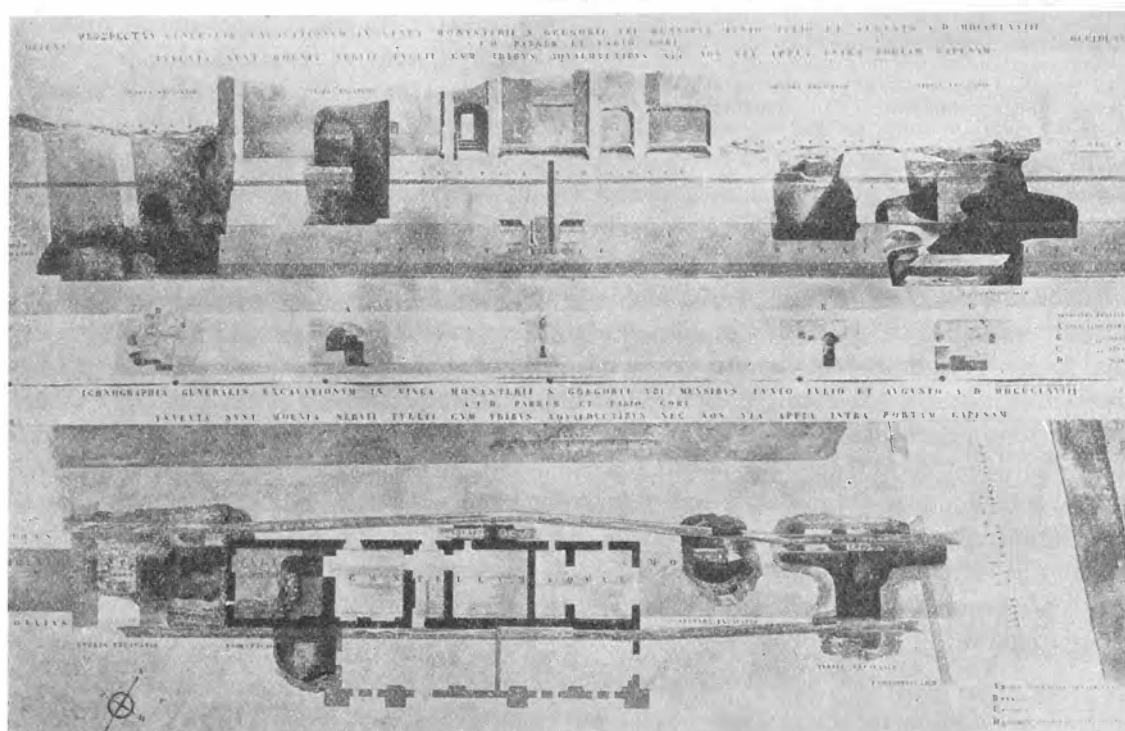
Pianta e prospetto dei ruderi scoperti dal Parker nella Valle di porta Capena. (Cicconetti.)
